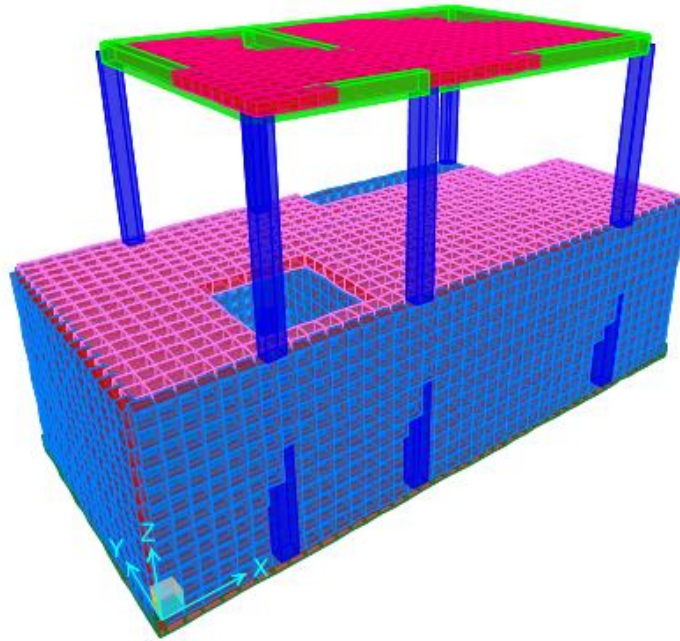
Vista assonometrica modello struttura in elevazione - elementi estrusi
